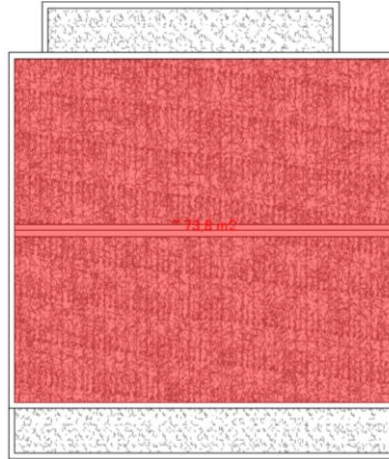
Planta da cobertura (Fonte: Elaborada pela autora).
